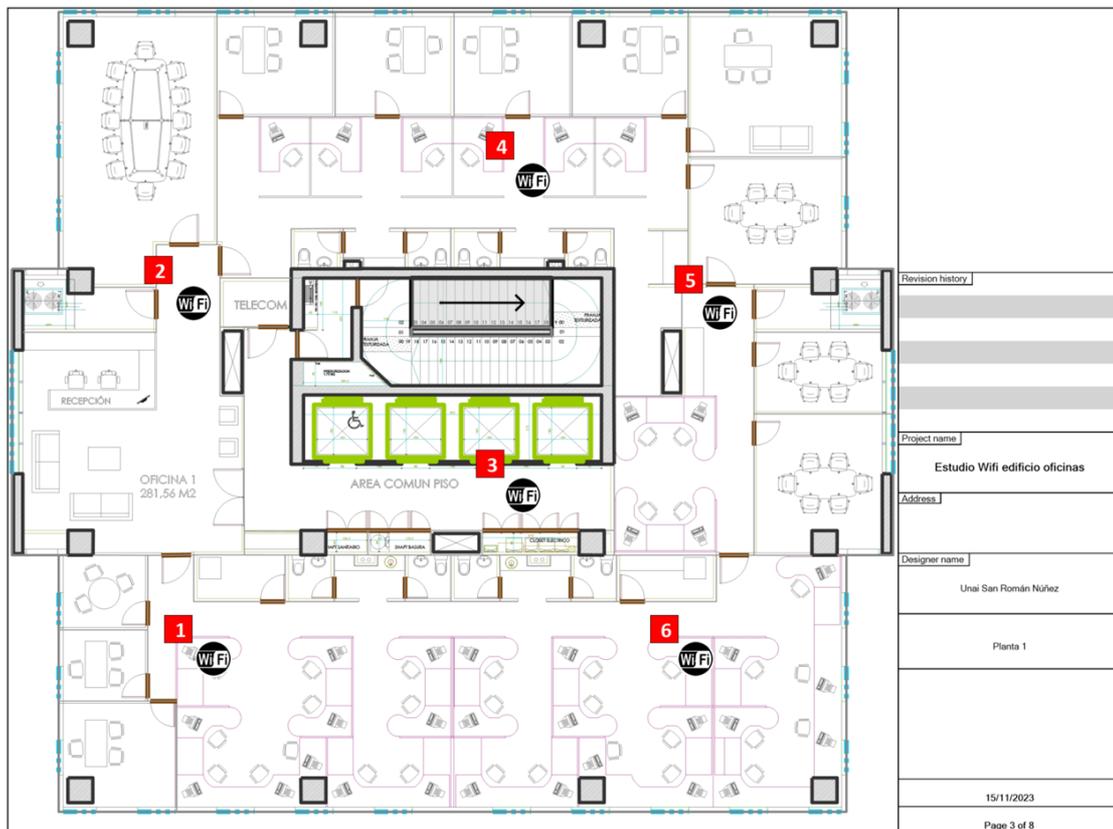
Posicionamiento Puntos de Acceso. Planta 1.
